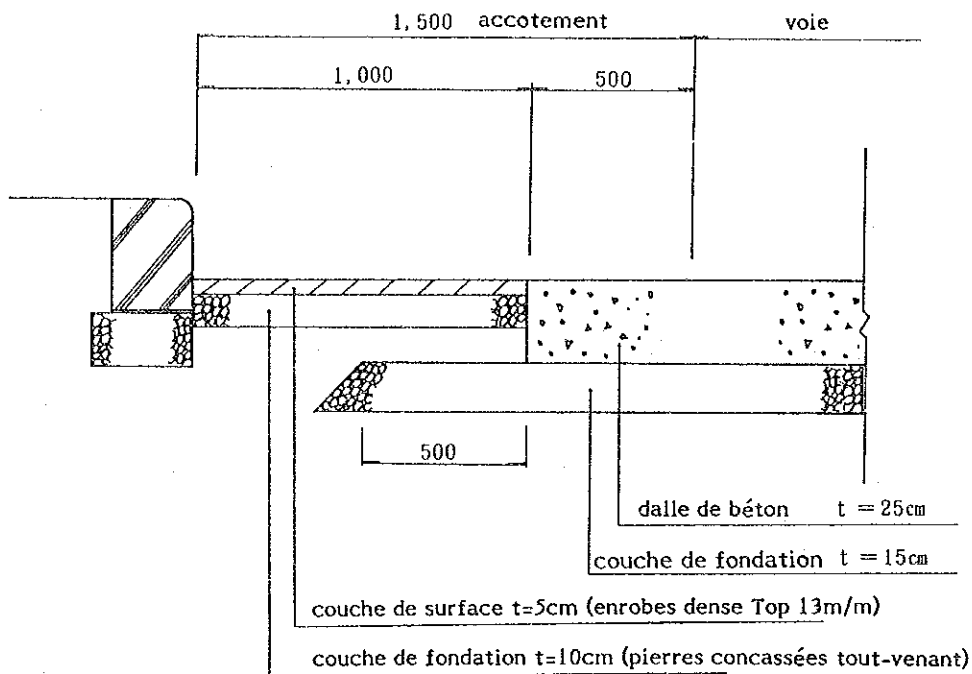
Structure de revêtement de l'accotement et de la chaussée
